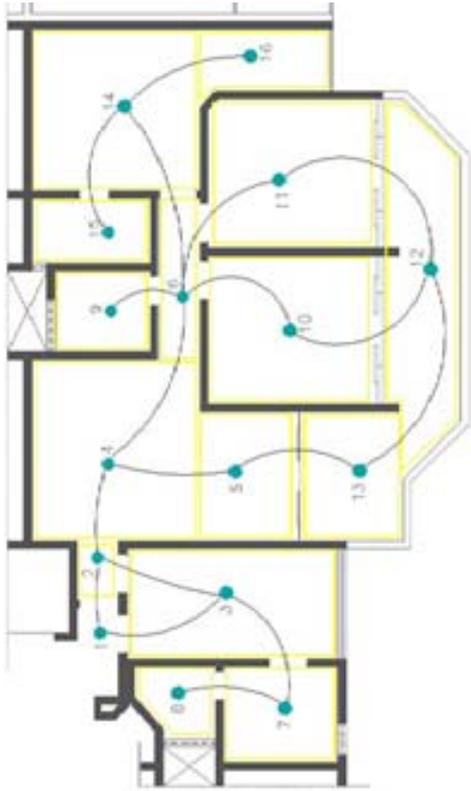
SQSW 304, Bloco C – Sudoeste – Planta Original
